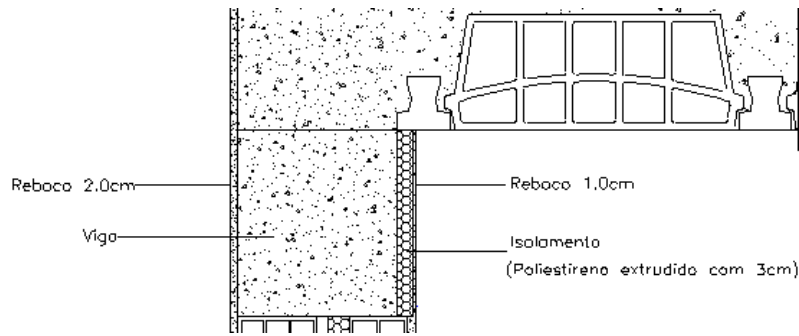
Zona de ponte térmica plana da viga da solução C
